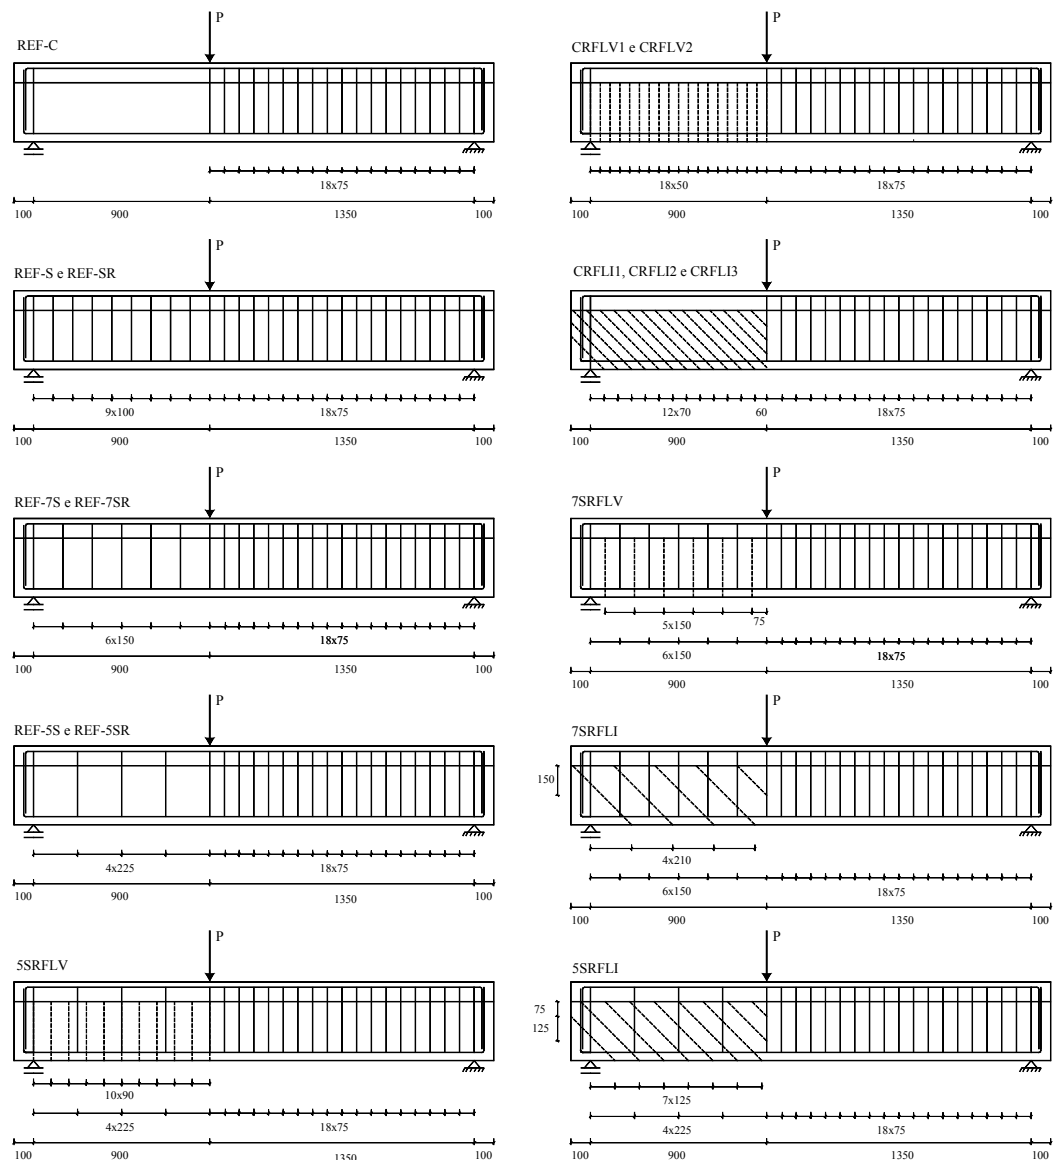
Vigas ensaiadas: localização das armaduras transversais (linha a traço cheio) e dos laminados de CFRP no reforço ao corte (linha a tracejado)
